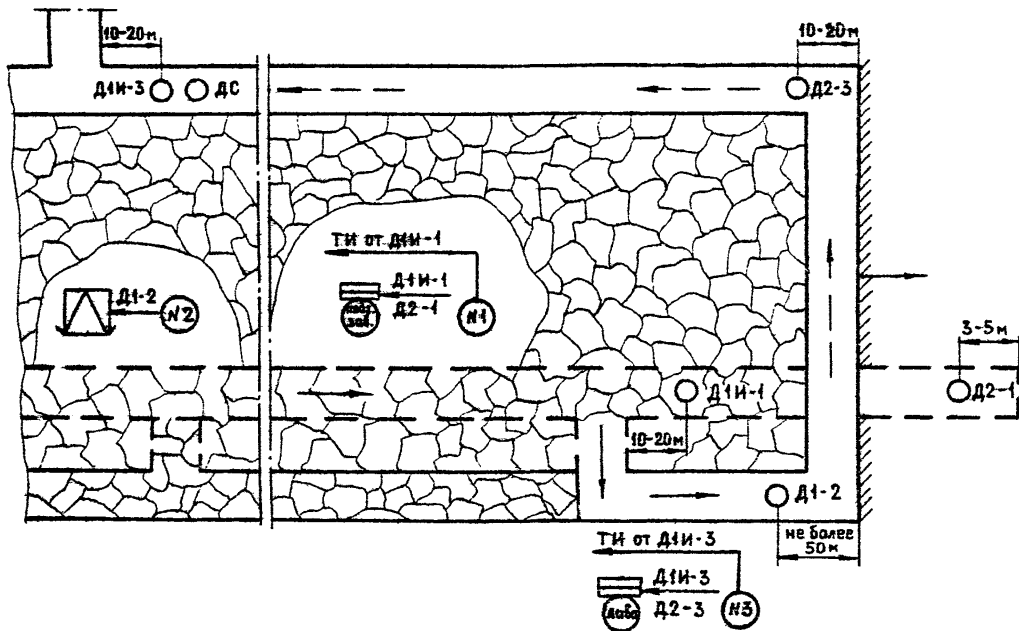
Схема размещения аппаратуры АГК при сплошной системе разработки с поперечным штреком
